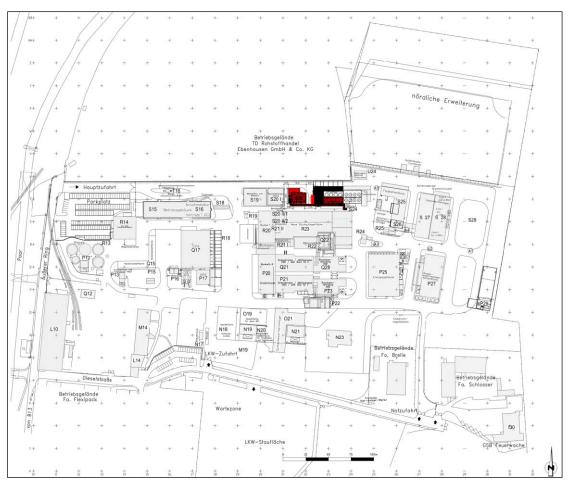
Lageplan des Tanklagers (Quelle: IA-Tech GmbH)
